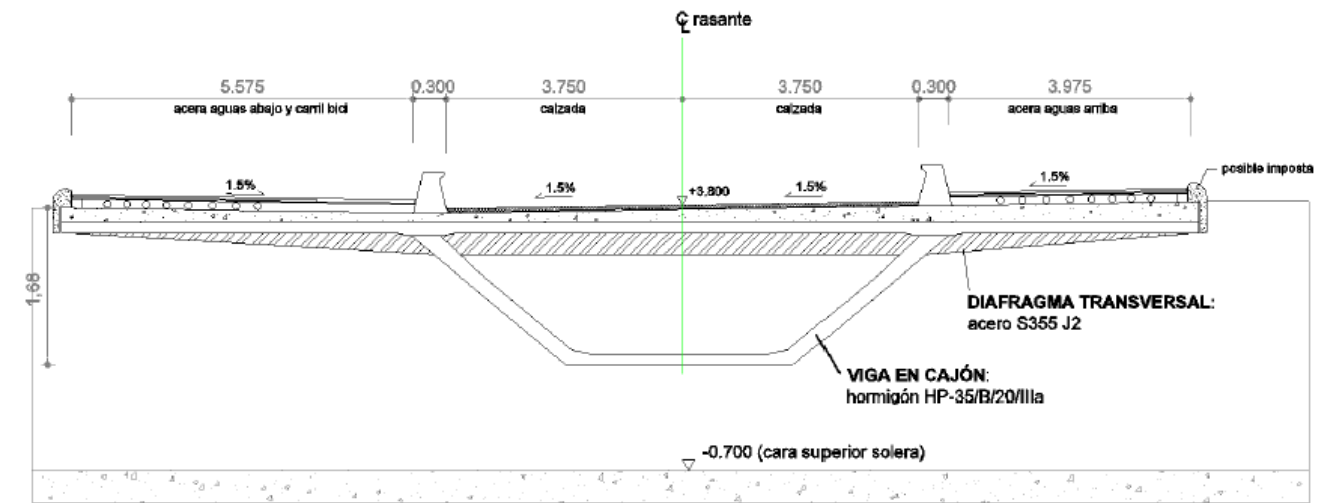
Propuesta B – Sección transversal del tablero en apoyos
